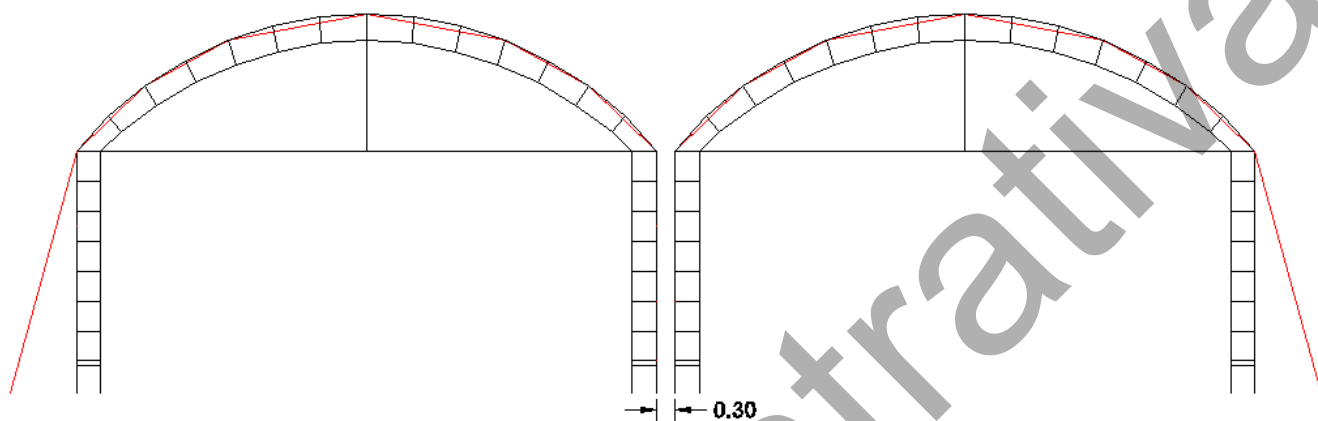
Disposizione delle strutture "gemelle": Prospetto
